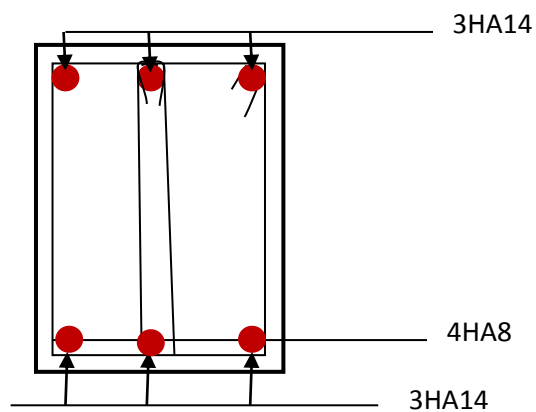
Ferrailage en travée d'une poutre secondaire.
